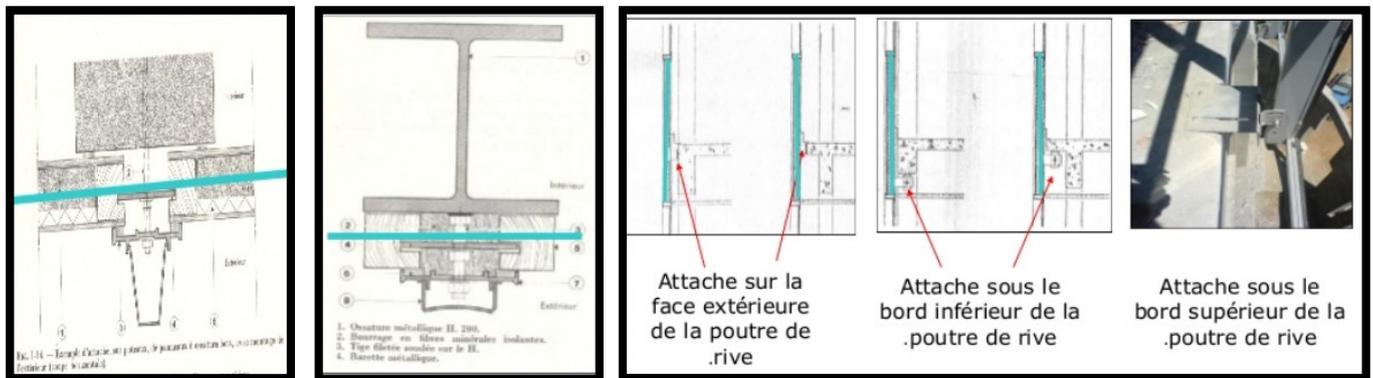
Fixation sur poteau en acier (à droite) et en béton (à gauche)
